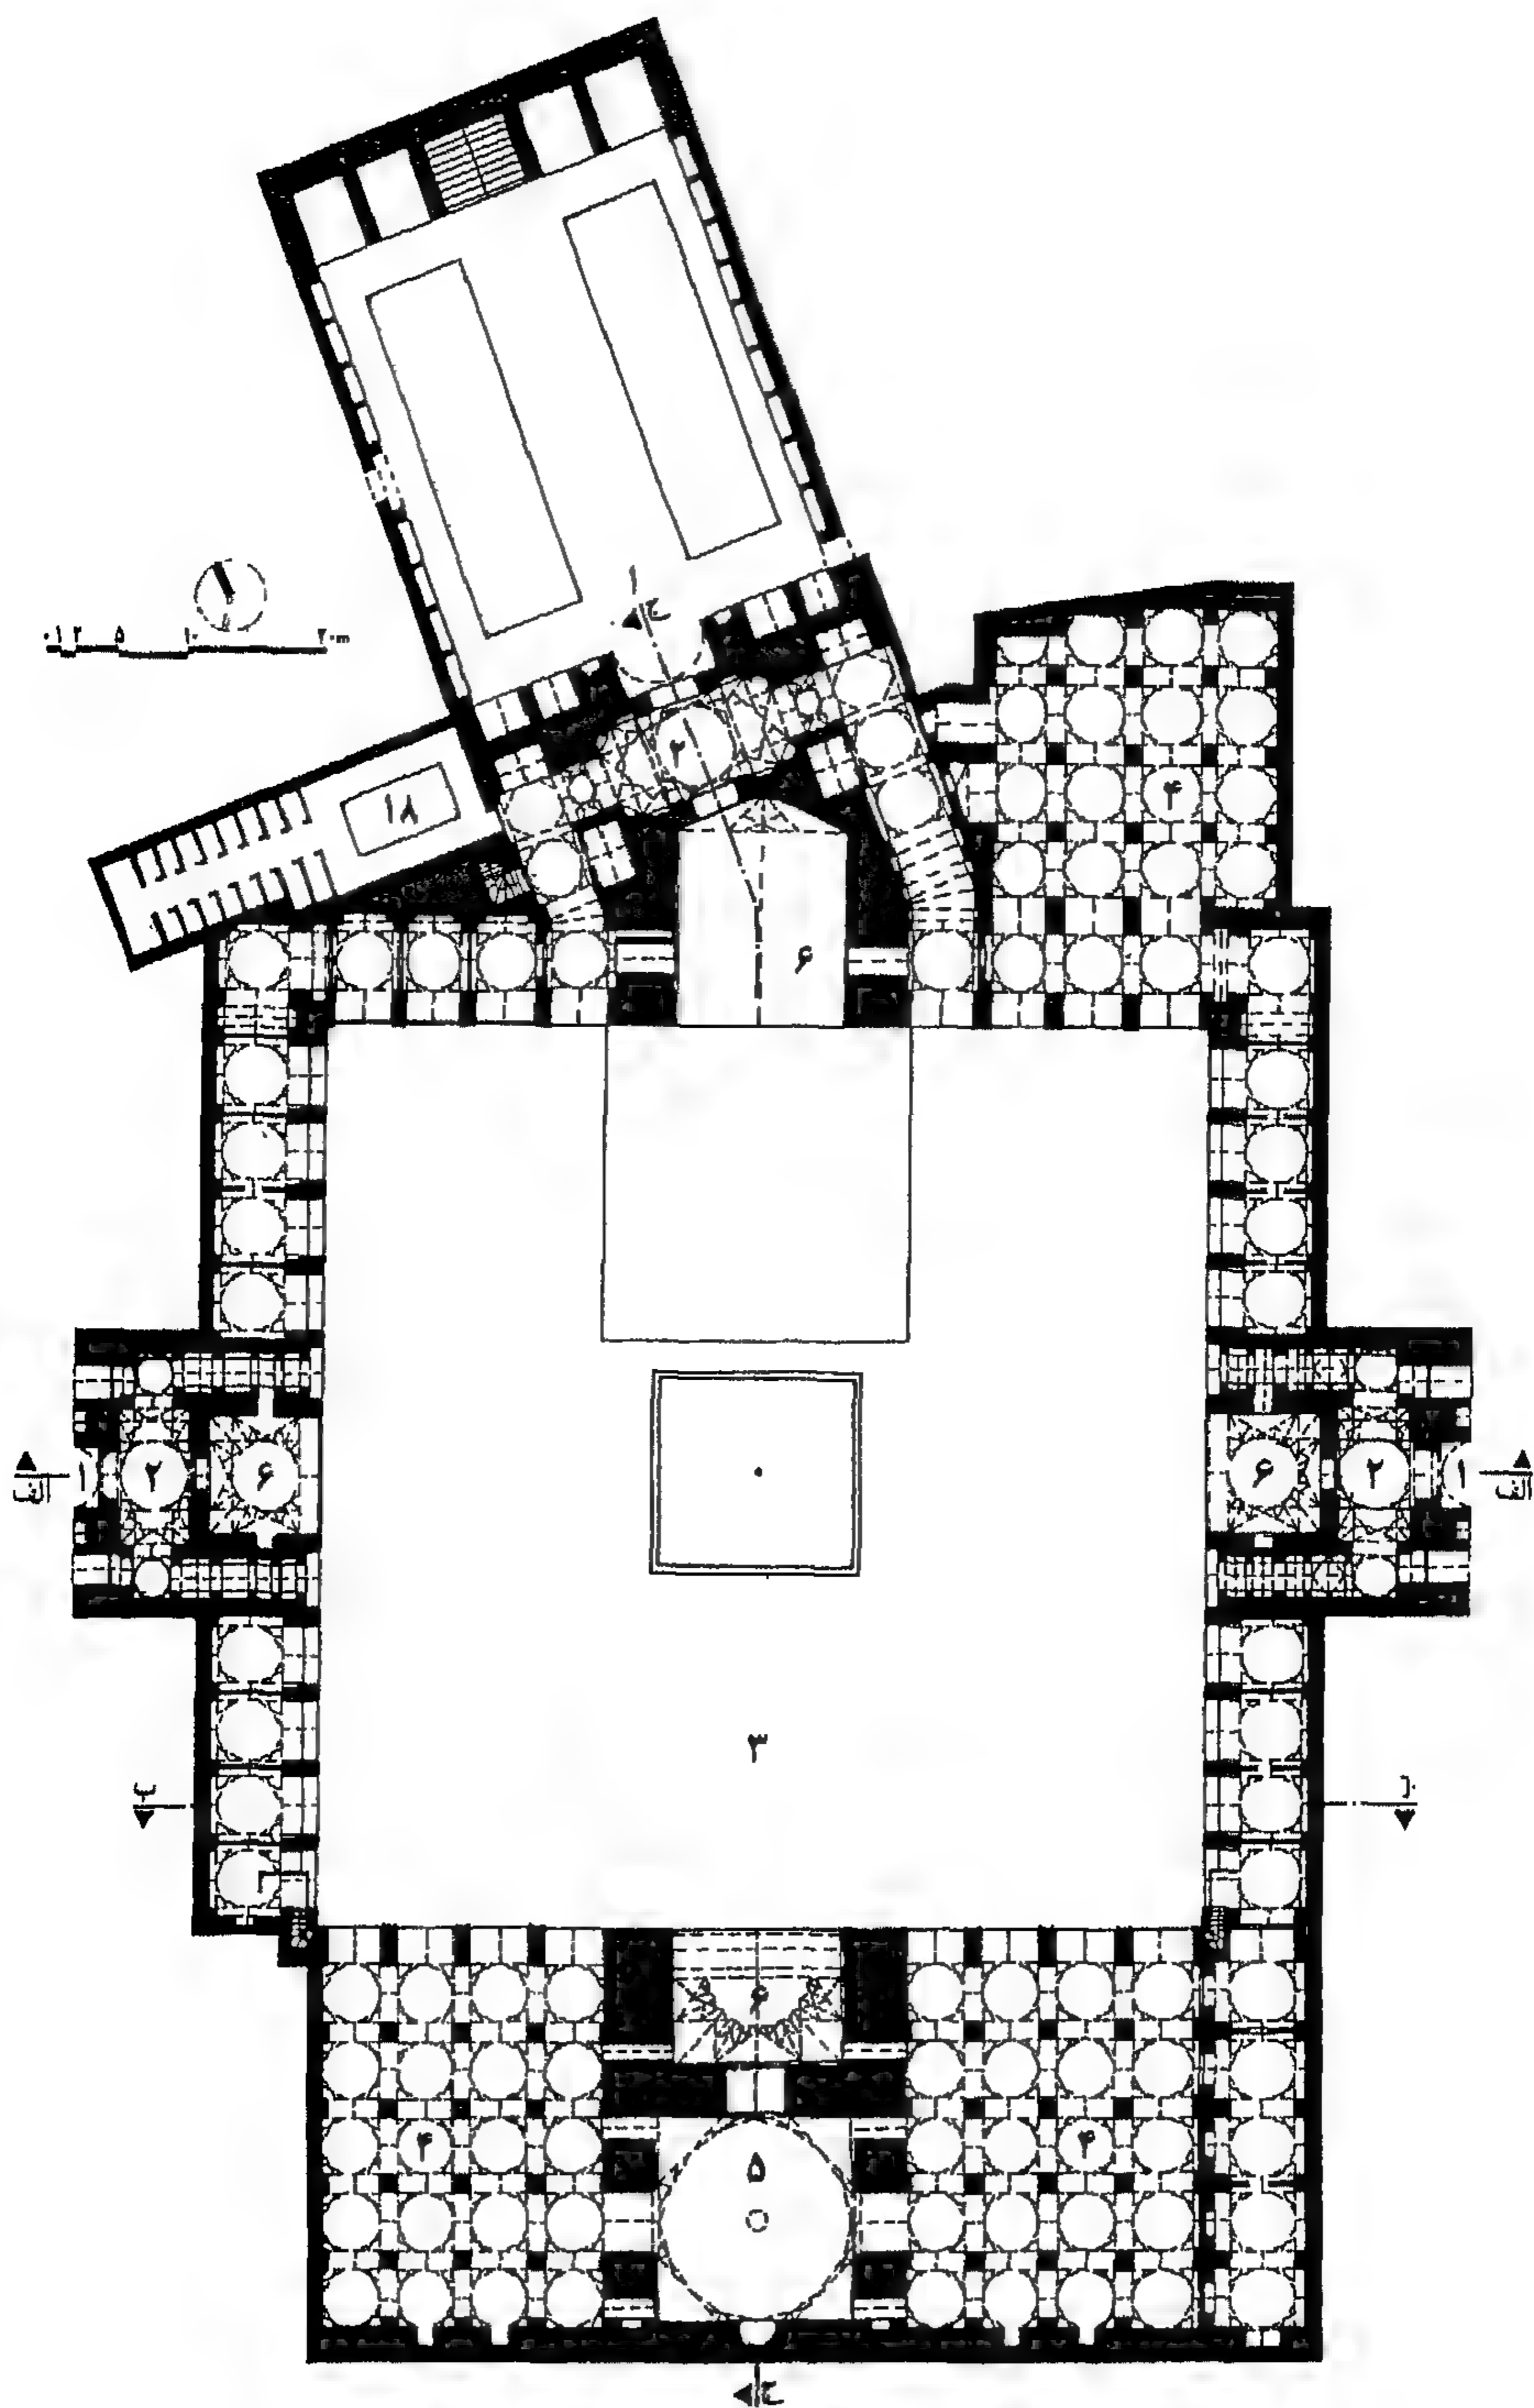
مسقط أفقي لمسجد جوهر شاد بمشهد .
